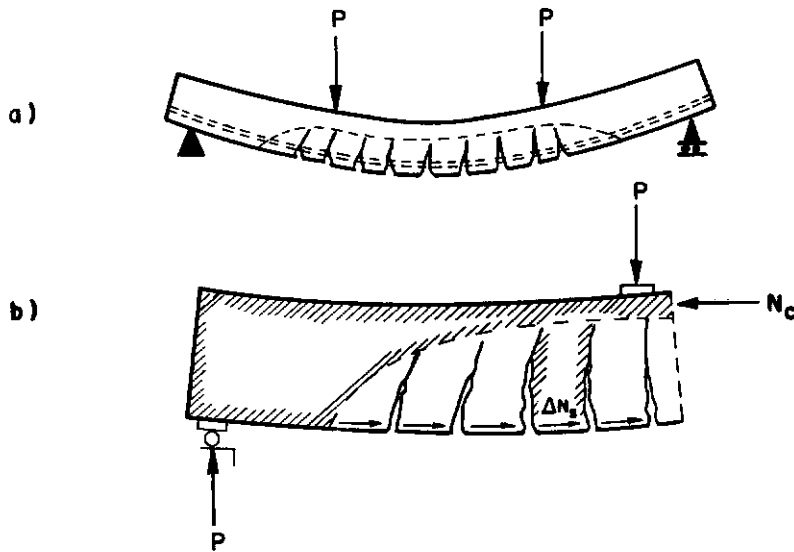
Transformação da viga de concreto armado numa estrutura semelhante a um pente.
